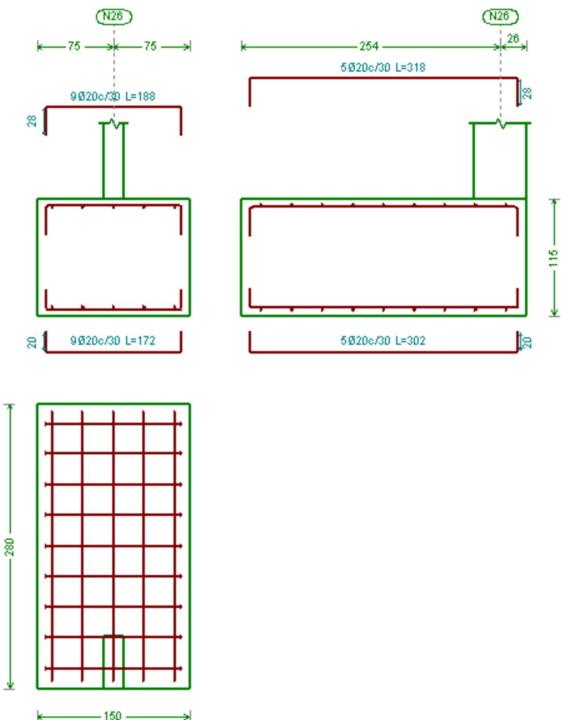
Disposición de los elementos de la cimentación. Fuente: CYPE 3D.
